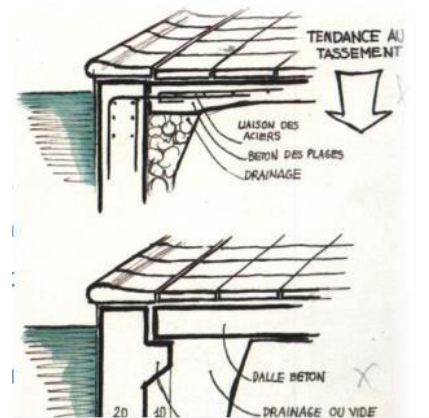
Détail du ferrailage de l'appui d'une plage sur un chéneau de piscine à débordement
